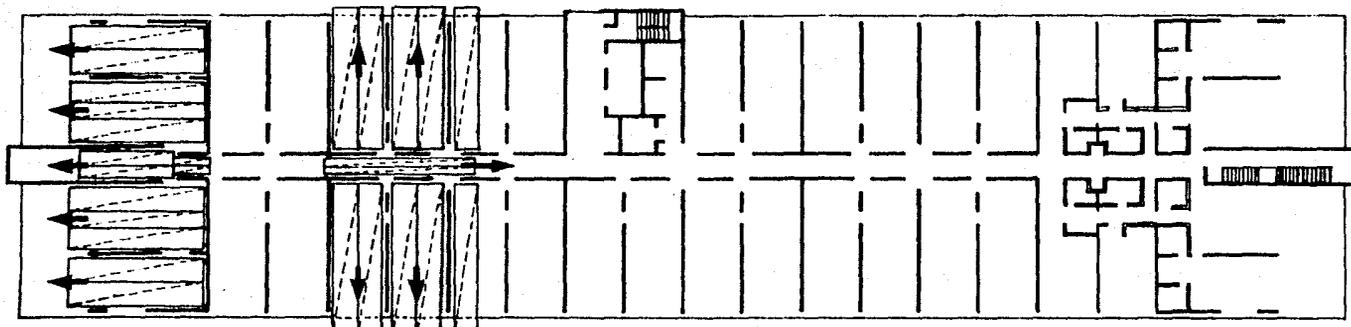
Planta tipo de los condominios construidos en Cancún
